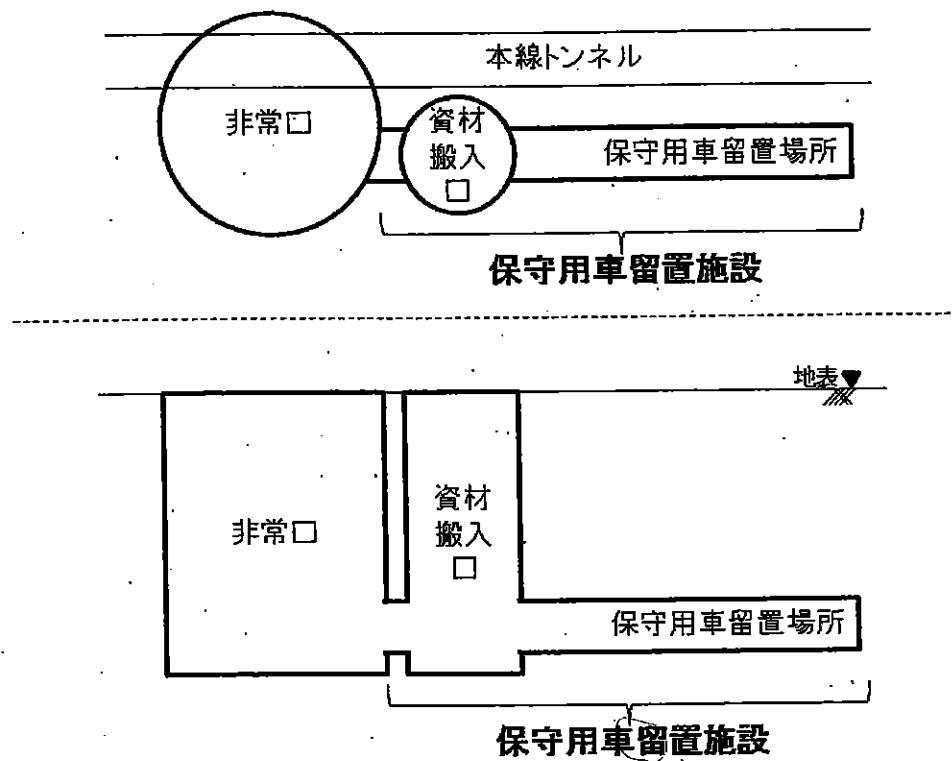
保守用車留置施設の概要（上段が平面図、下段が側面図）
